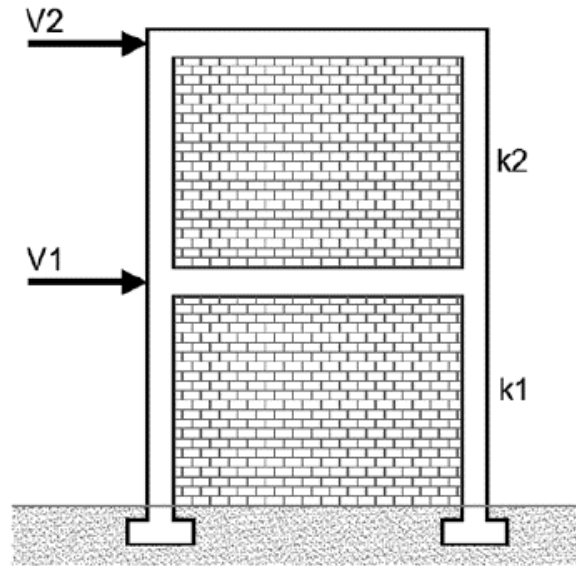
Sistema estructural de gran rigidez lateral. Fuente: Retrofitting Design of Building Structures, Xilin Lu (2010).
